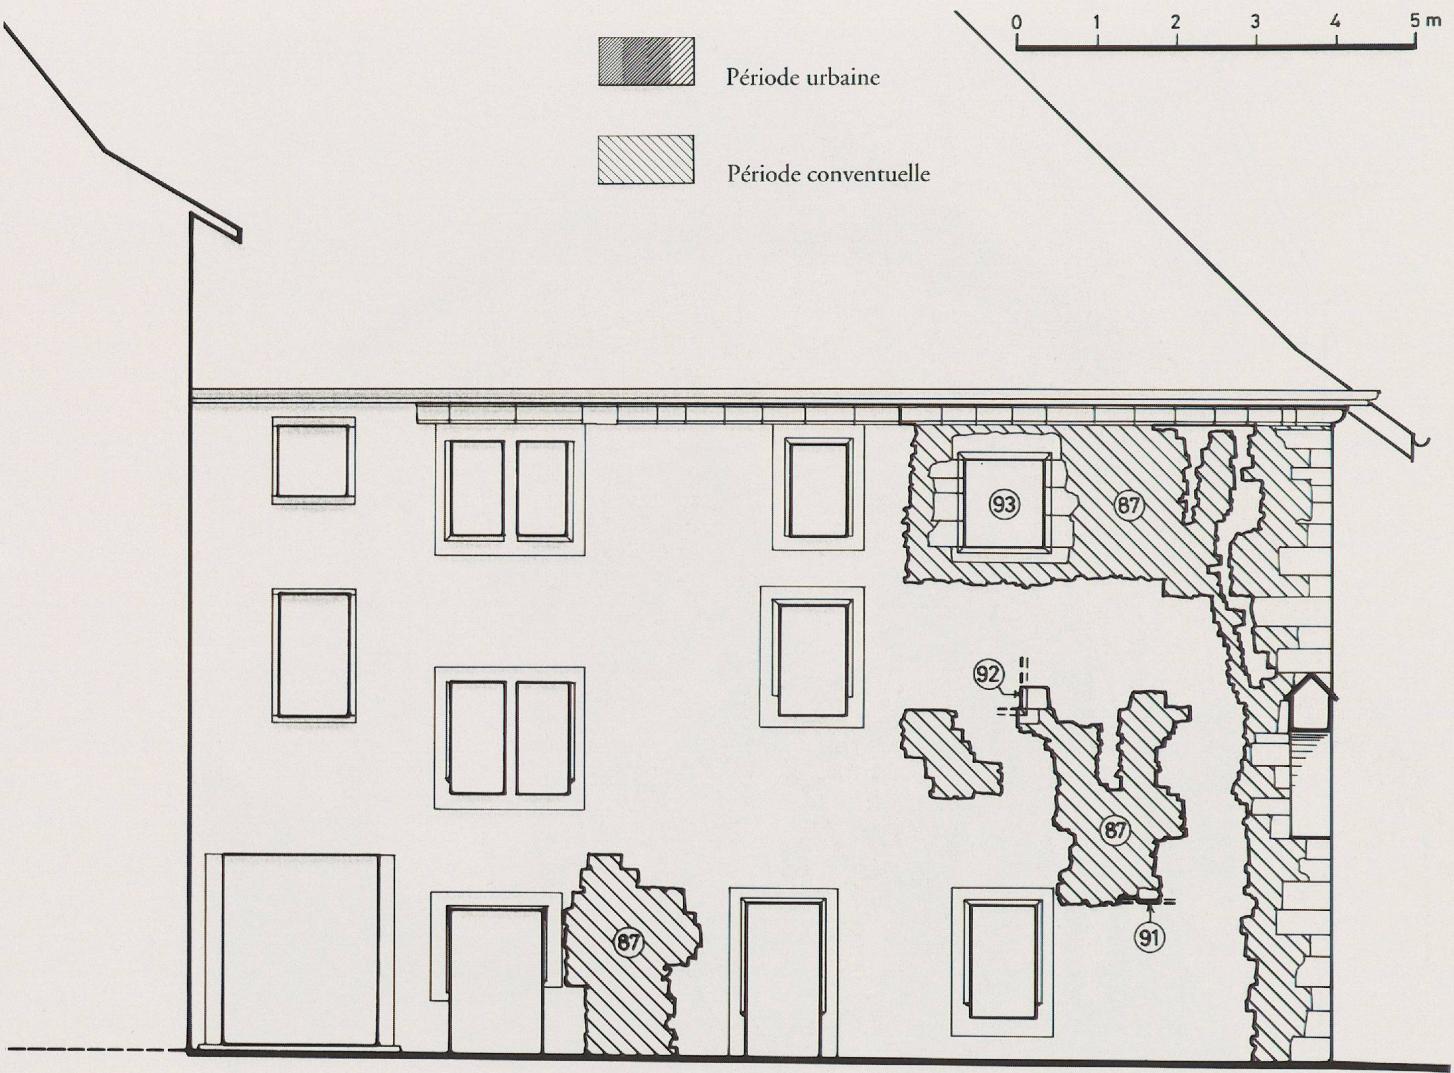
Le «Vieux Couvent», structures préconventionnelles et conventionnelles sur le mur de façade nord. Ech.: 1:100.
